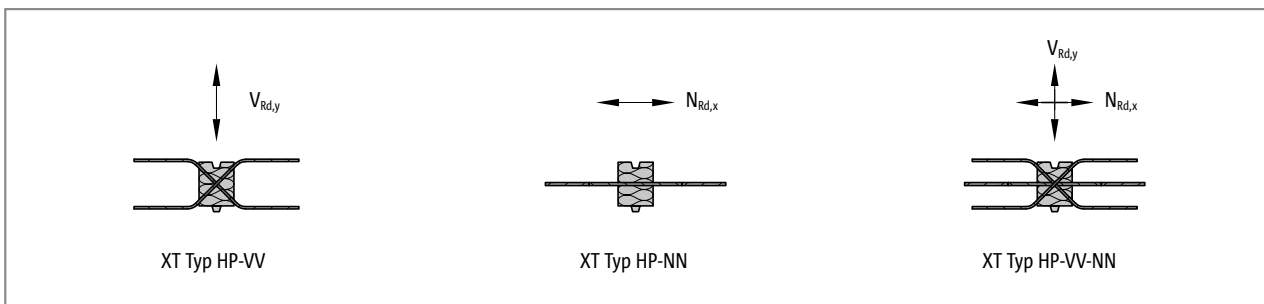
Schöck Isokorb® XT Typ HP: Typenauswahl
